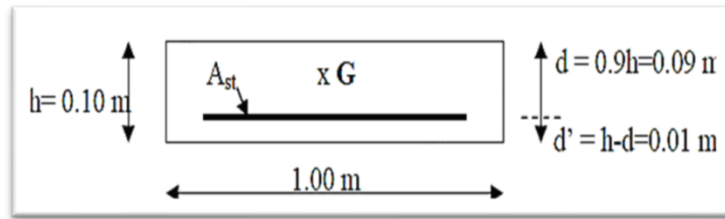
Section de calcul de ferrailage d'acrotère [21]
